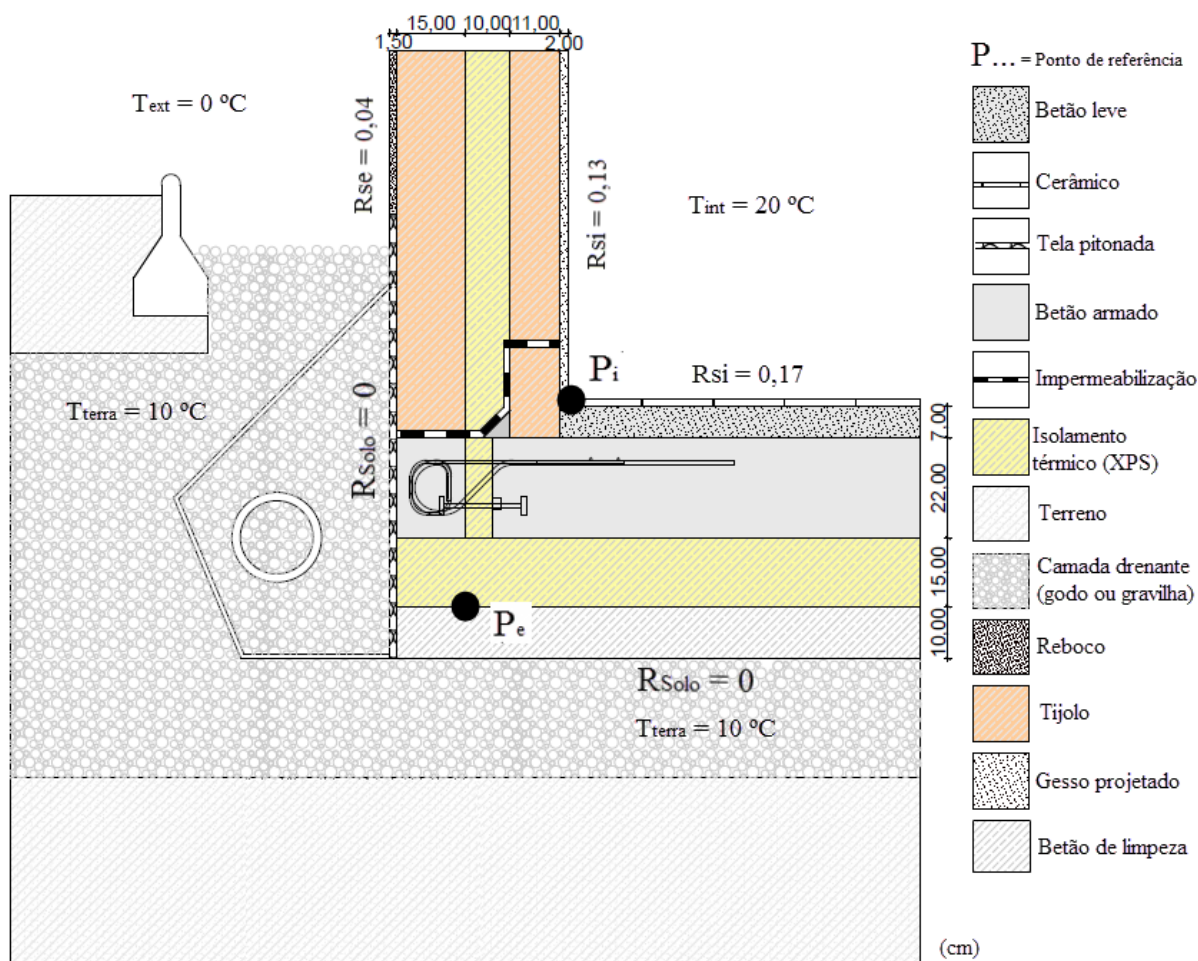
Ligação de fachada (parede dupla) com pavimentos térreos (ensoleiramento)
